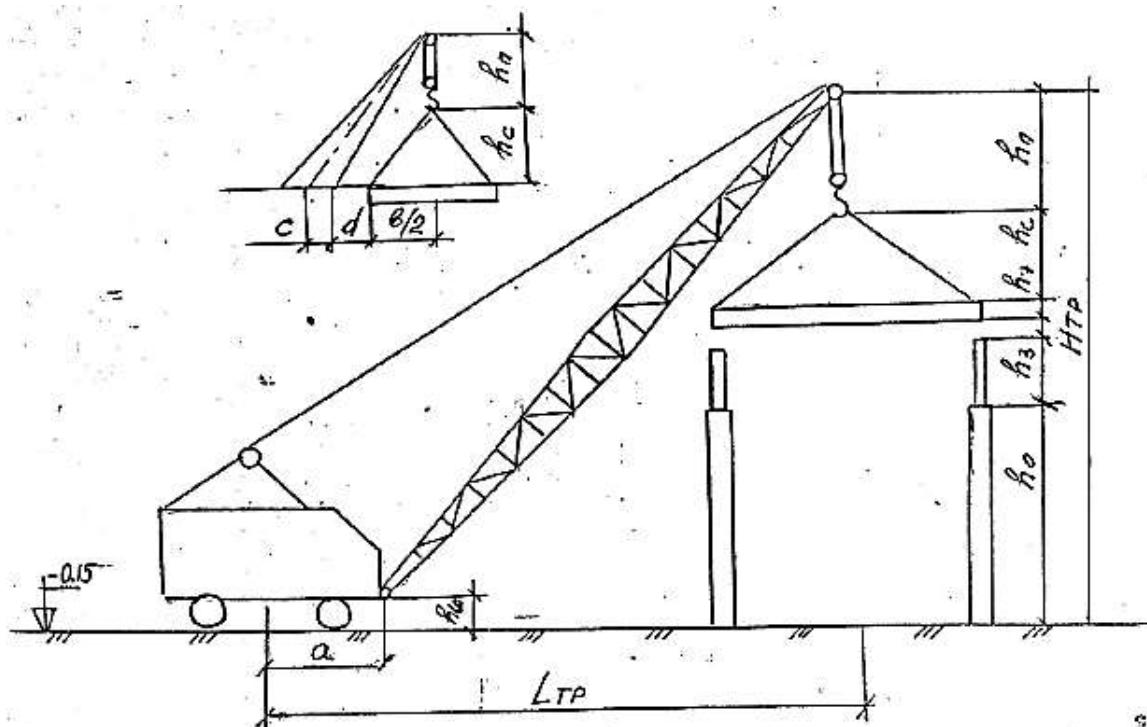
Схема монтажа здания (для плиты покрытия) самоходным стреловым краном
